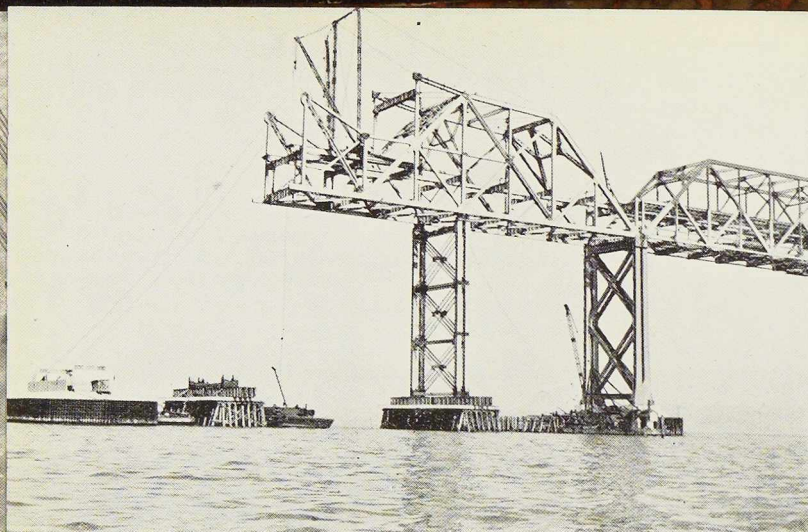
Construction de la travée d'ancrage du pont cantilever. A l'extrême gauche, on aperçoit la pile définitive en construction.
